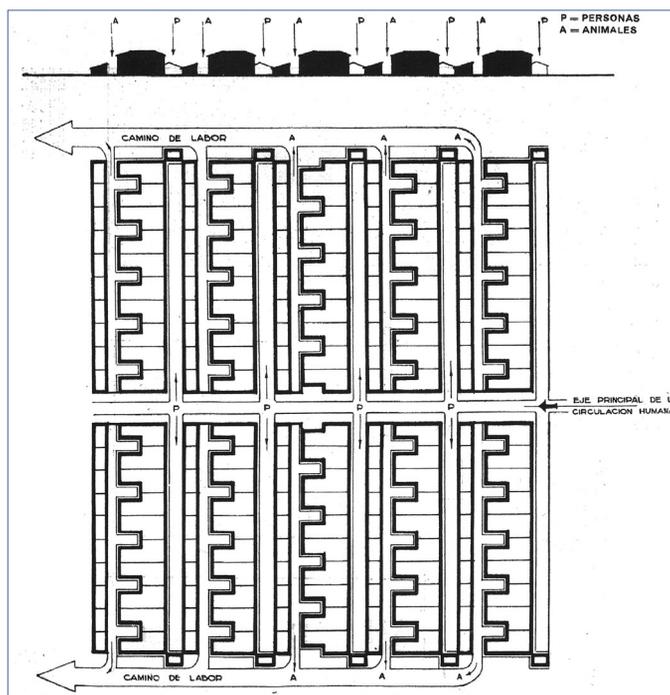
Sección y planta de conjunto de la propuesta de separación de calles de personas y senderos de animales propuesta por los arquitectos Alejandro Herrero en colaboración con Guillermo Cabrerizo, 1945.
